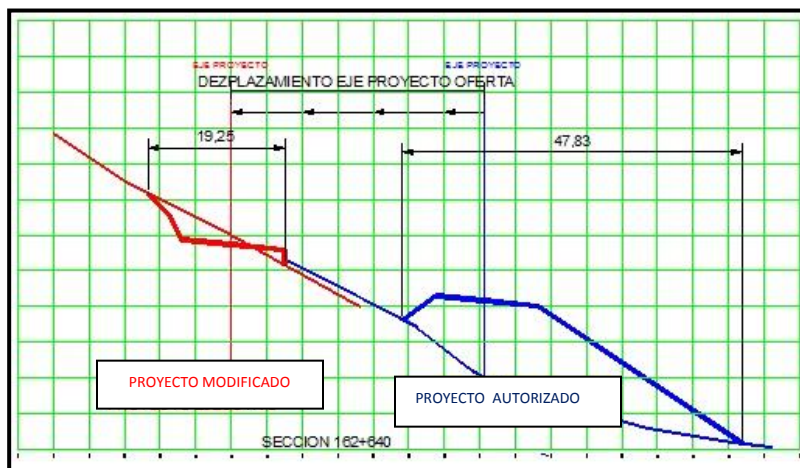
Mejora de sección de proyecto modificado km 162+640.00
